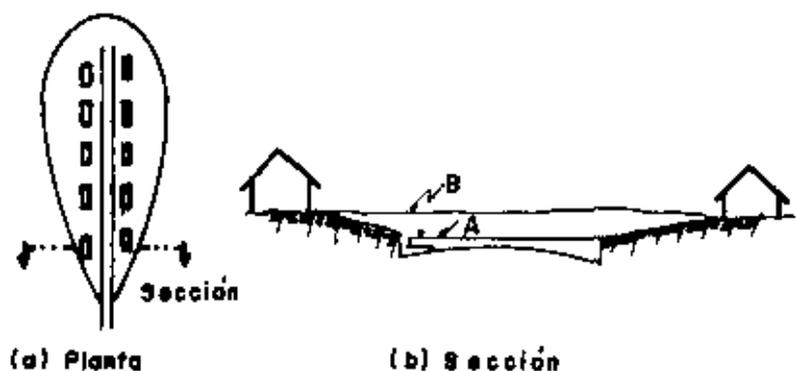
DESAGUE URBANO SIMPLE, PLANTA Y CORTE TRANSVERSAL.
